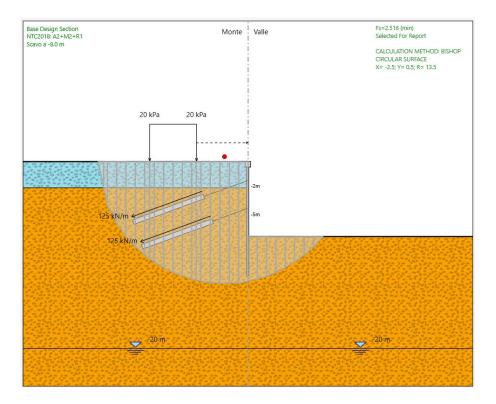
Sezione Tipo C - Condizioni statiche (FS=2.5)
